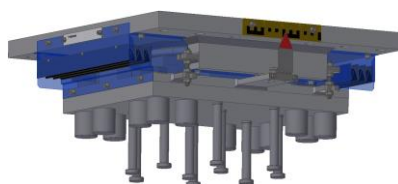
Lagertyp KGe,L, Edelstahlbleche transparent dargestellt, oben Stahl & unten Betonanschluss.
